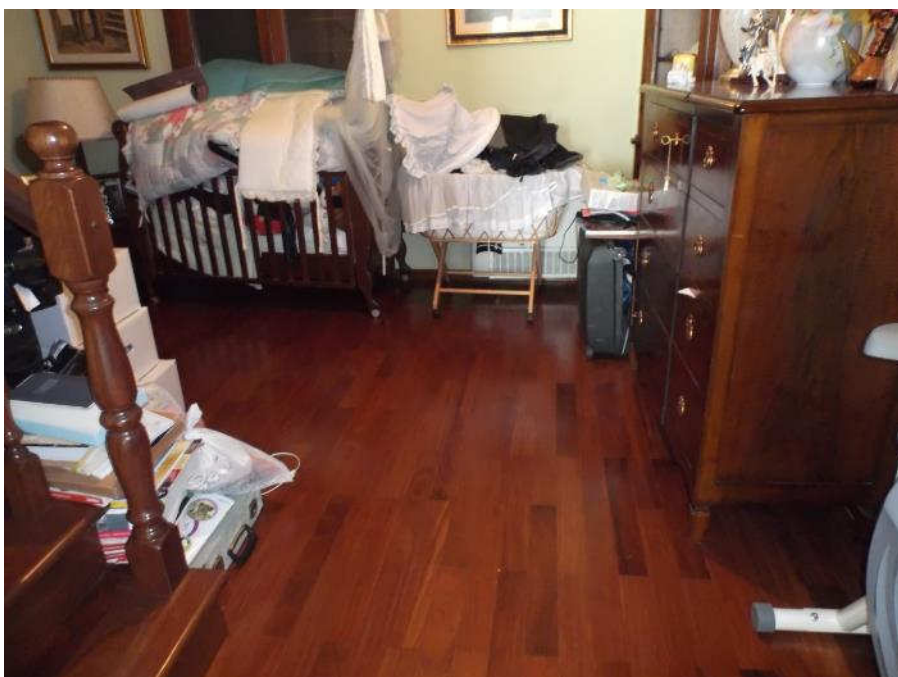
Piano primo - Ripostiglio (Sub 9)
